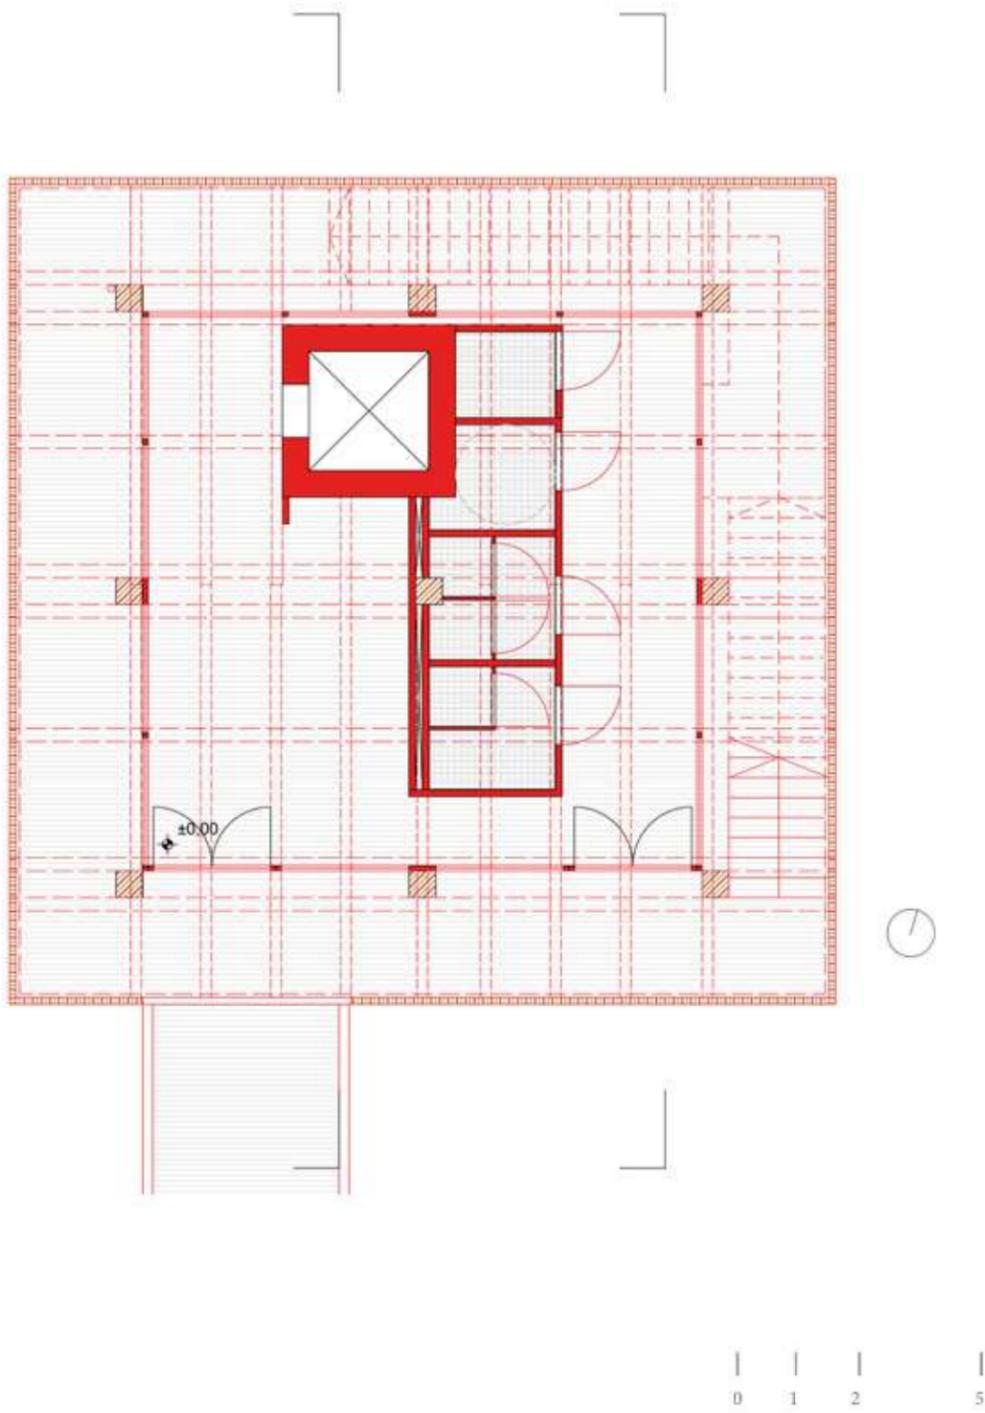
Grundriss Erdgeschoss Jagdkanzel, M 1:100
